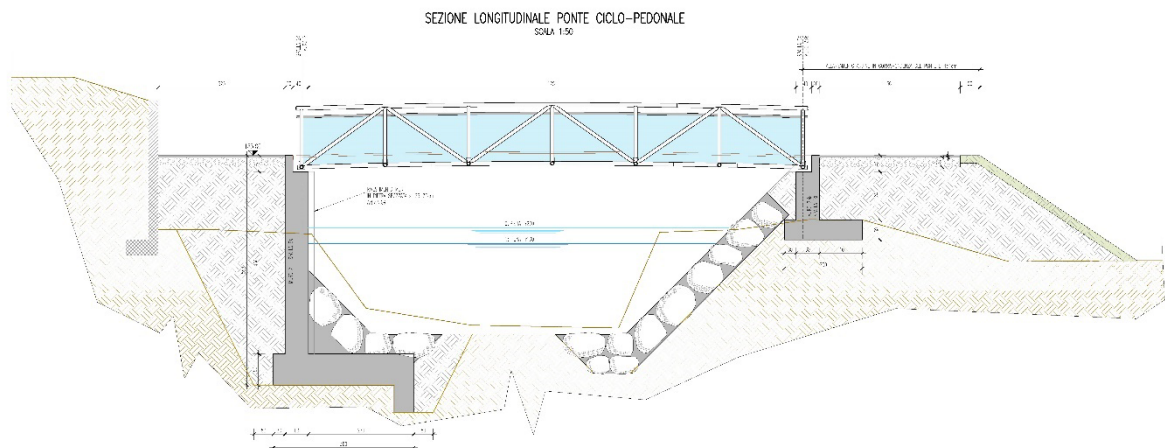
Sezione longitudinale passerella ciclopedonale
